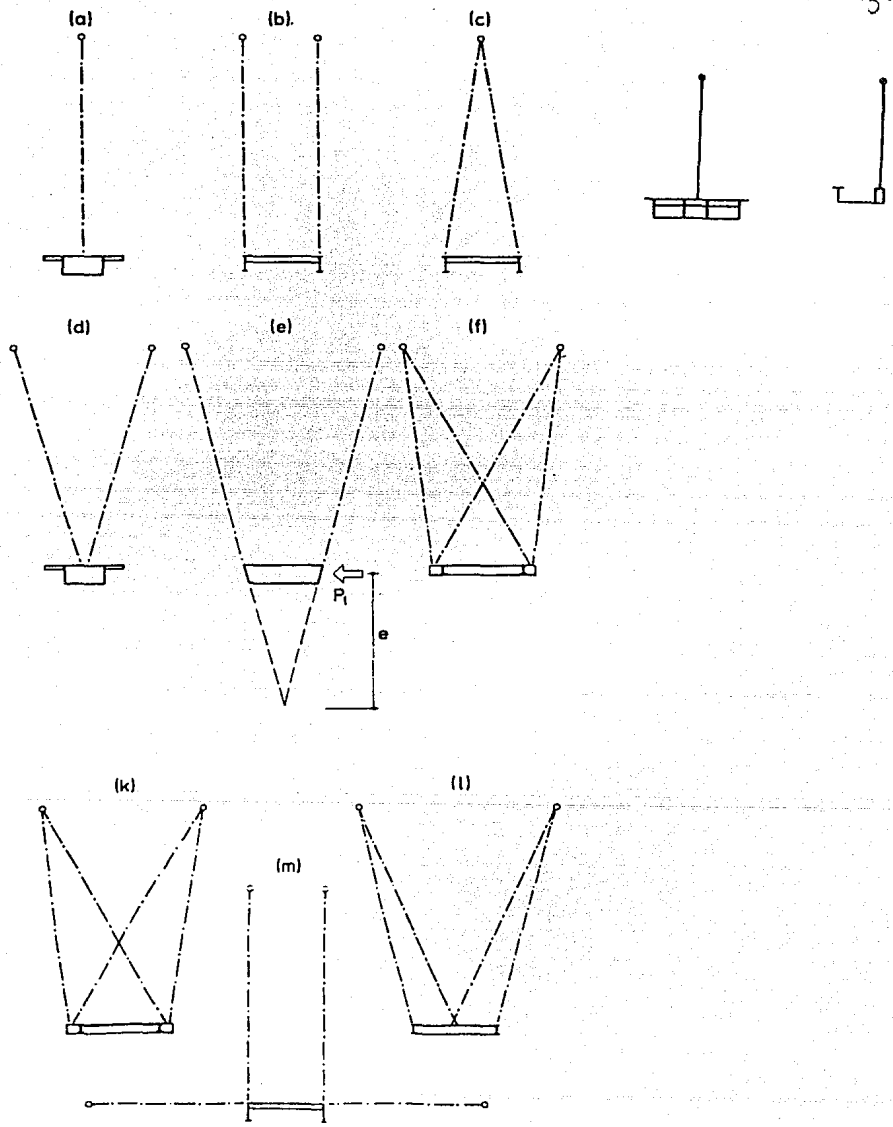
ARREGLOS DE PLANOS DE CABLES.
